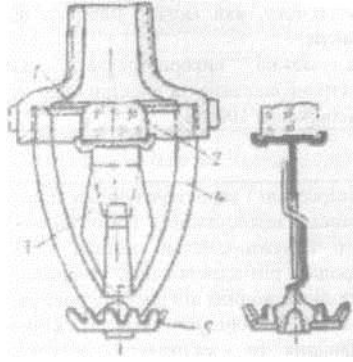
Пристрій спринклерної голівки: 1 — металева діафрагма; 2 — скляний клапан; 3 — замок; 4 — рама; 5 — розетка
